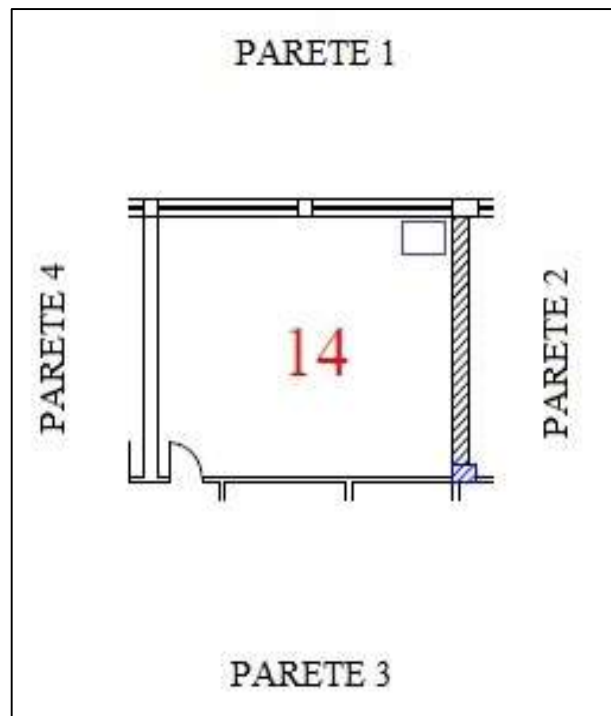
Planimetria dell'Aula 14 (Laboratorio Ceramica) oggetto di misurazioni
